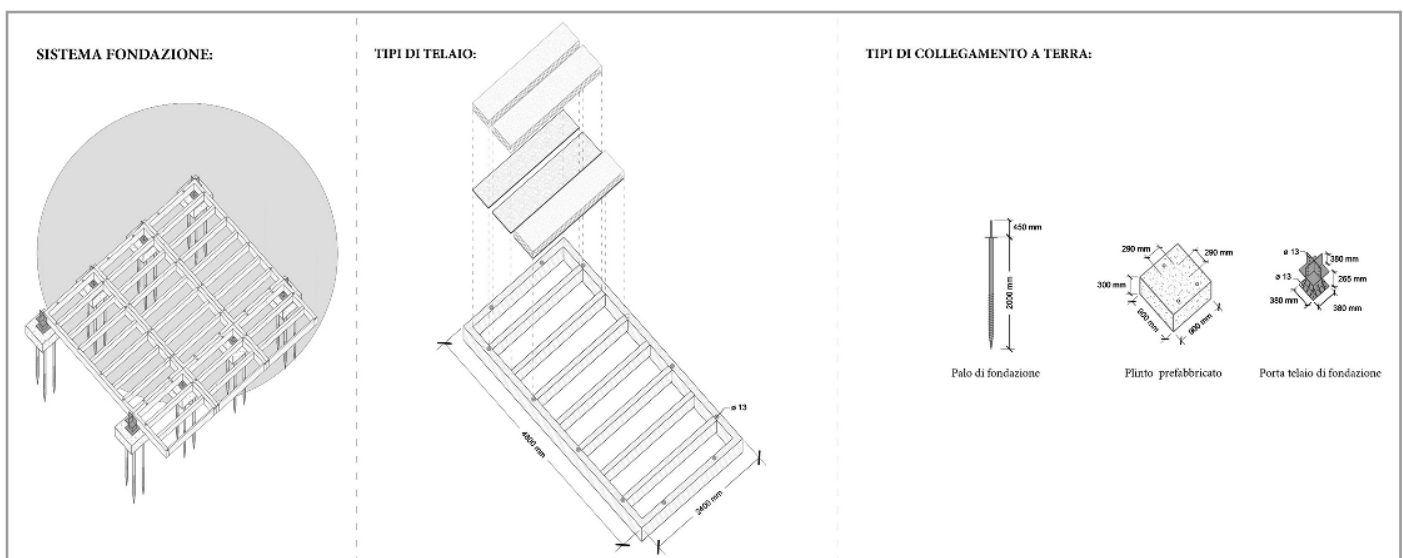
Schema delle fondazioni con gli elementi che le compongono
